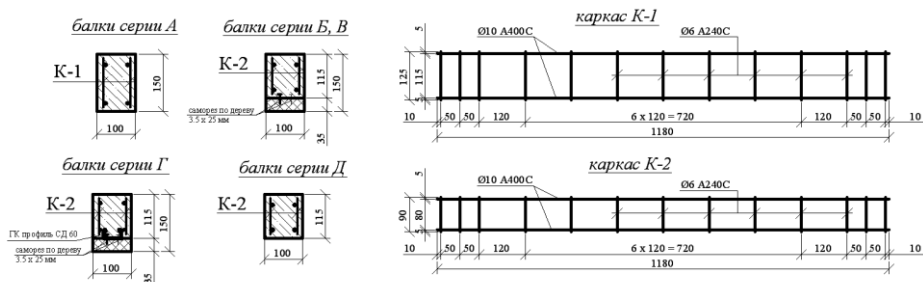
Поперечные сечения и армирование опытных балок серий А-Д.
